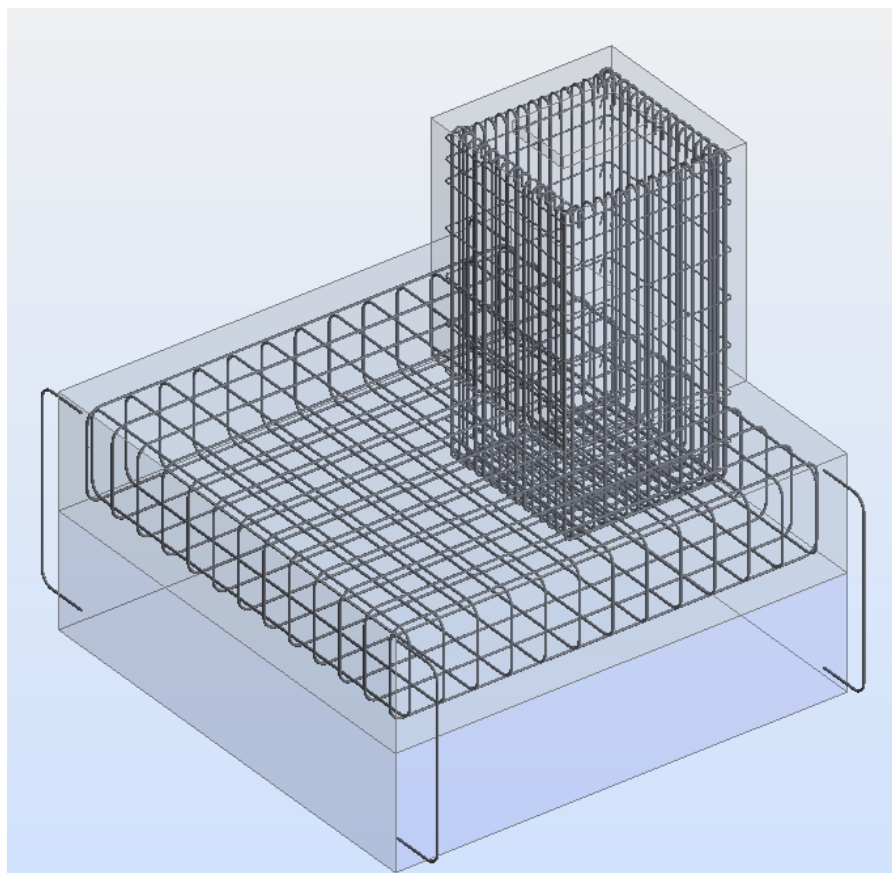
Vue en 3D de ferrailage de la semelle
